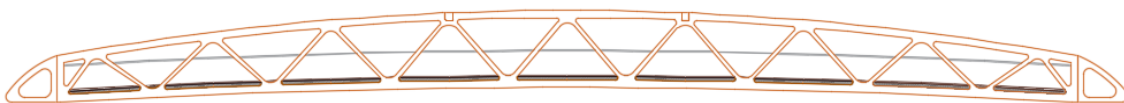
Alzado solución desarrollada (Fuente Elaboración propia)
